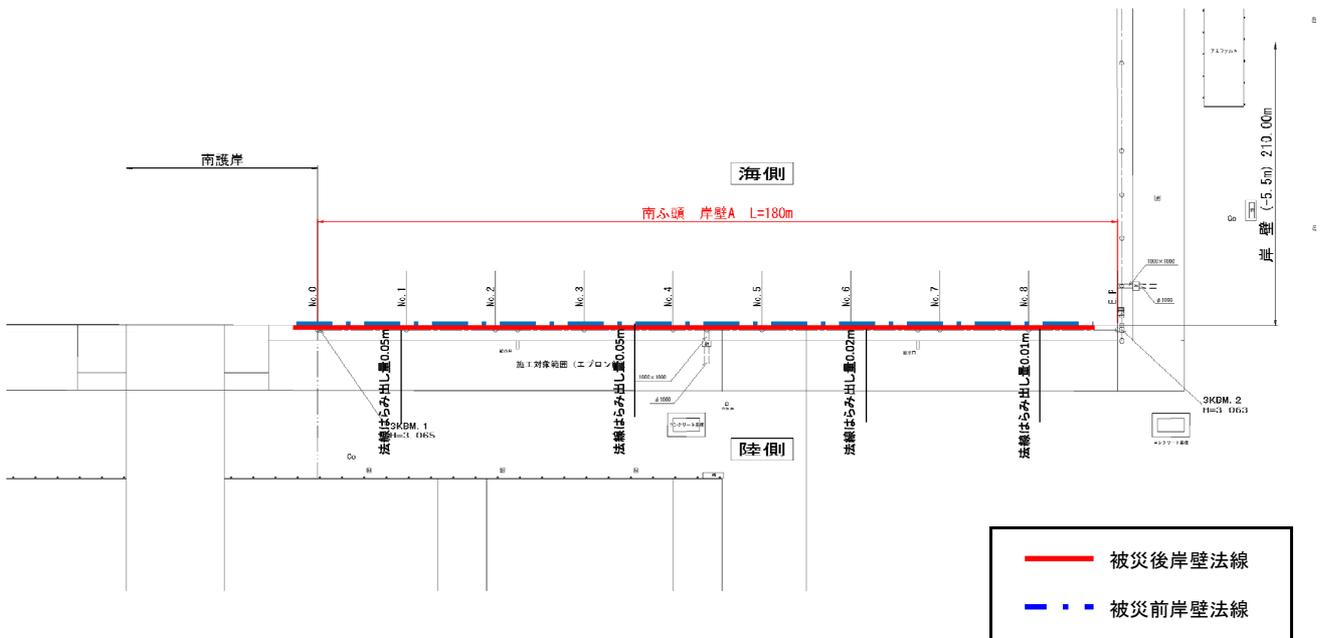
No.21 常陸那珂港区_南ふ頭地区 A 岸壁 (-5.5m) の平面図 (被災後)
